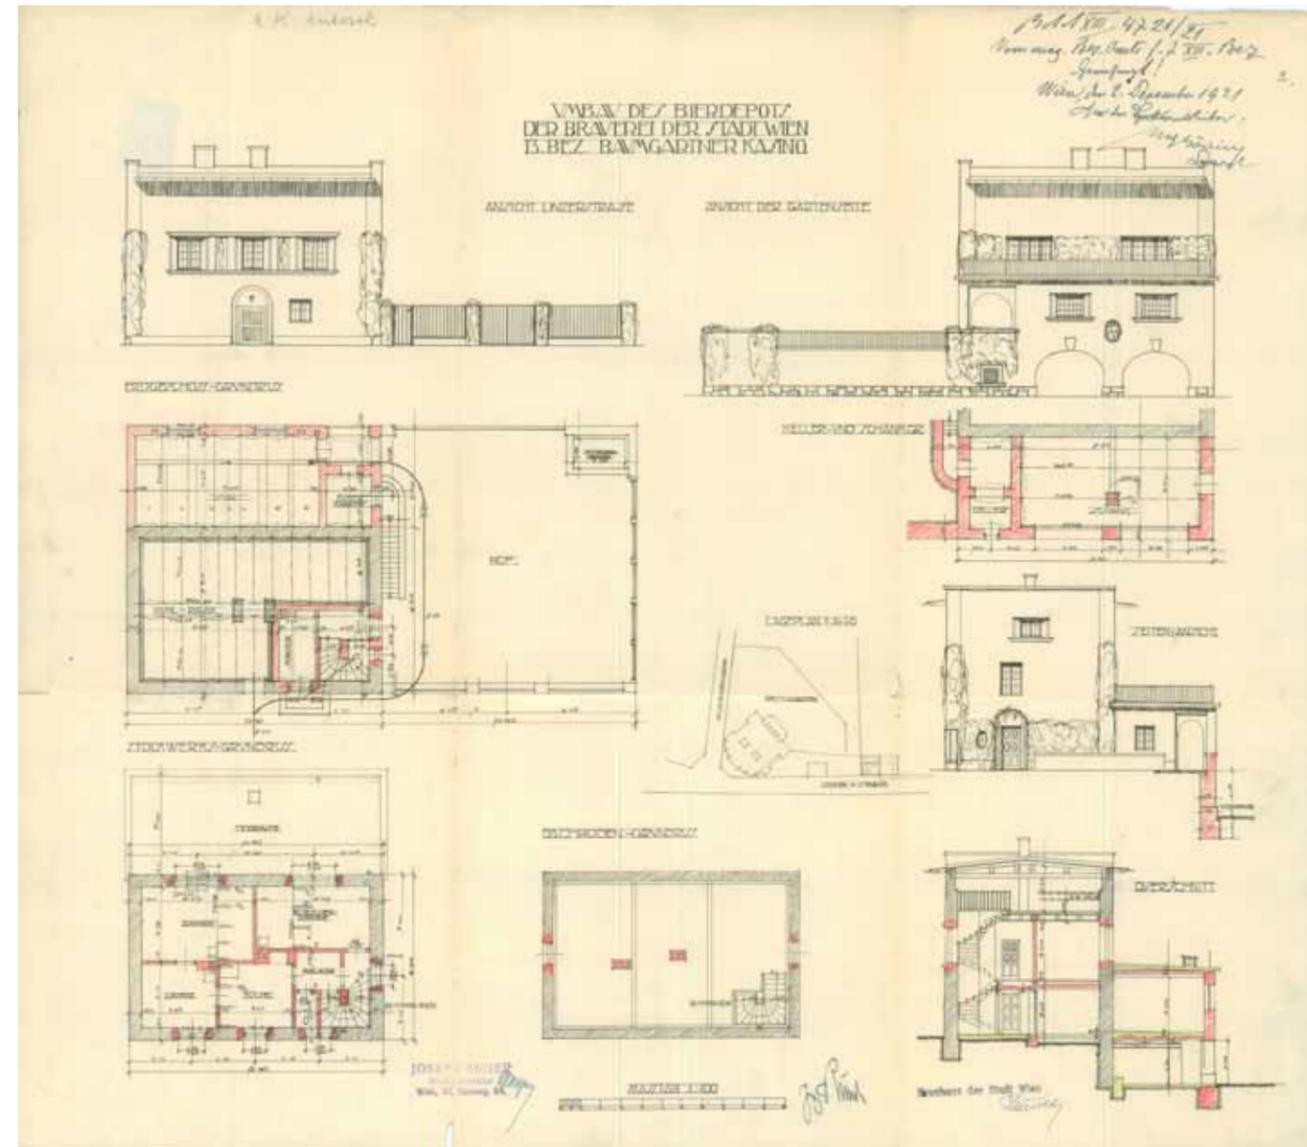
▲ Einreichplan für den Umbau des Bierdepots der Stadt Wien » 02.12.1921
